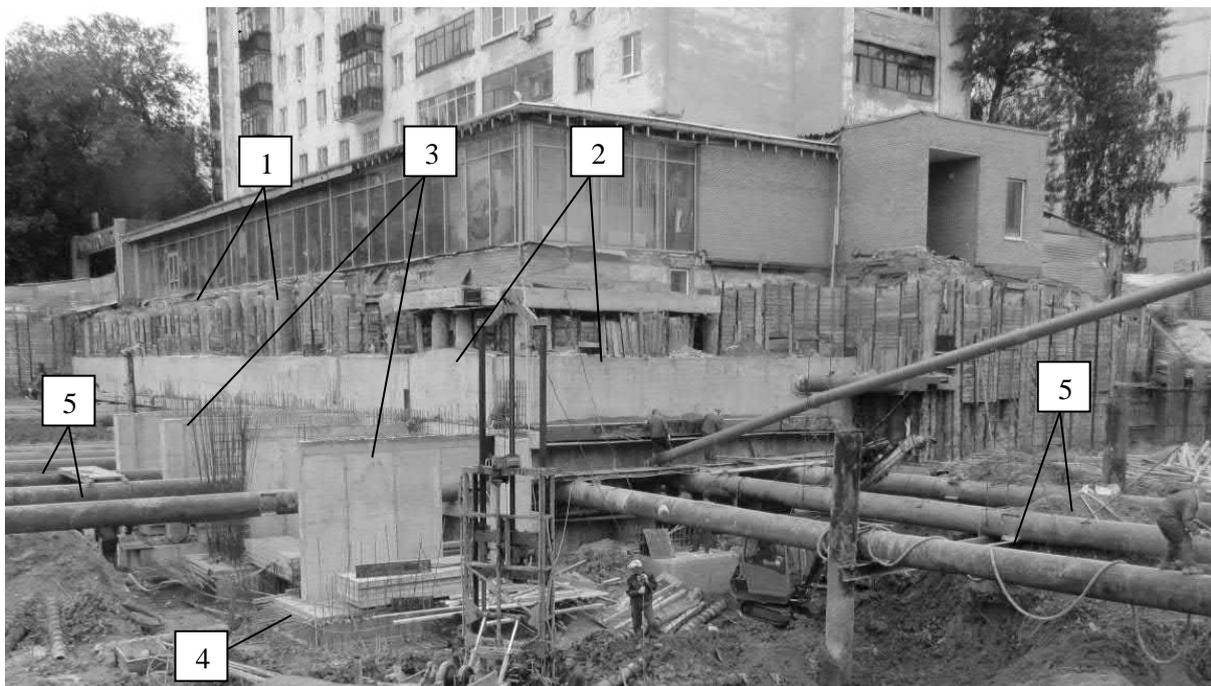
Схема закрепления подпорных стен котлована расстрелами из стальных труб 1000 мм: 1 - существующие буронабивные сваи ограждения котлована; 2 - ограждение котлована из монолитного железобетона; 3 - монолитные железобетонные контрфорсы усиления существующей подпорной стены; 4 - монолитный железобетонный ростверк; 5 - существующие трубы - расстрелы усиления подпорных стен
